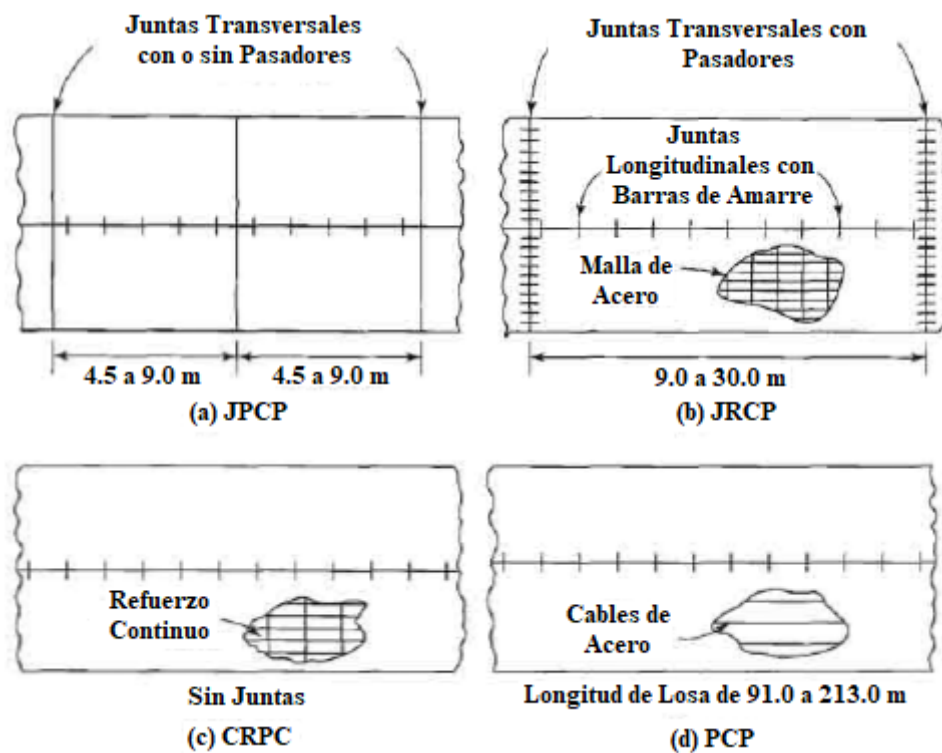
Tipos de pavimentos rígidos (Huang, 2004b)
